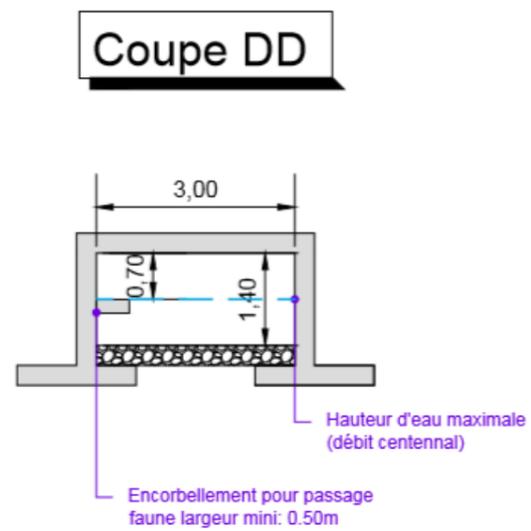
Profil en long et en travers de l'ouvrage cadre de transport hydraulique sur la section de Chamboret
